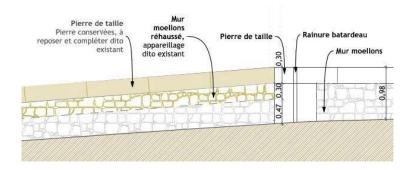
Détail de la réhausse du mur parapet le long de la rampe
